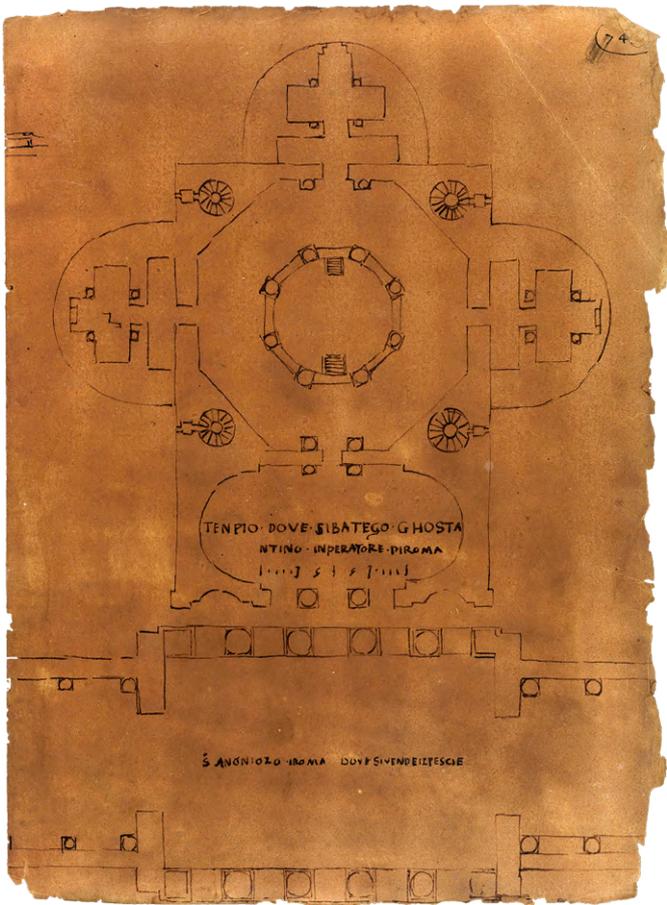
Giuliano da Sangallo, *Portico di Ottavia*, prospetto, pianta e
